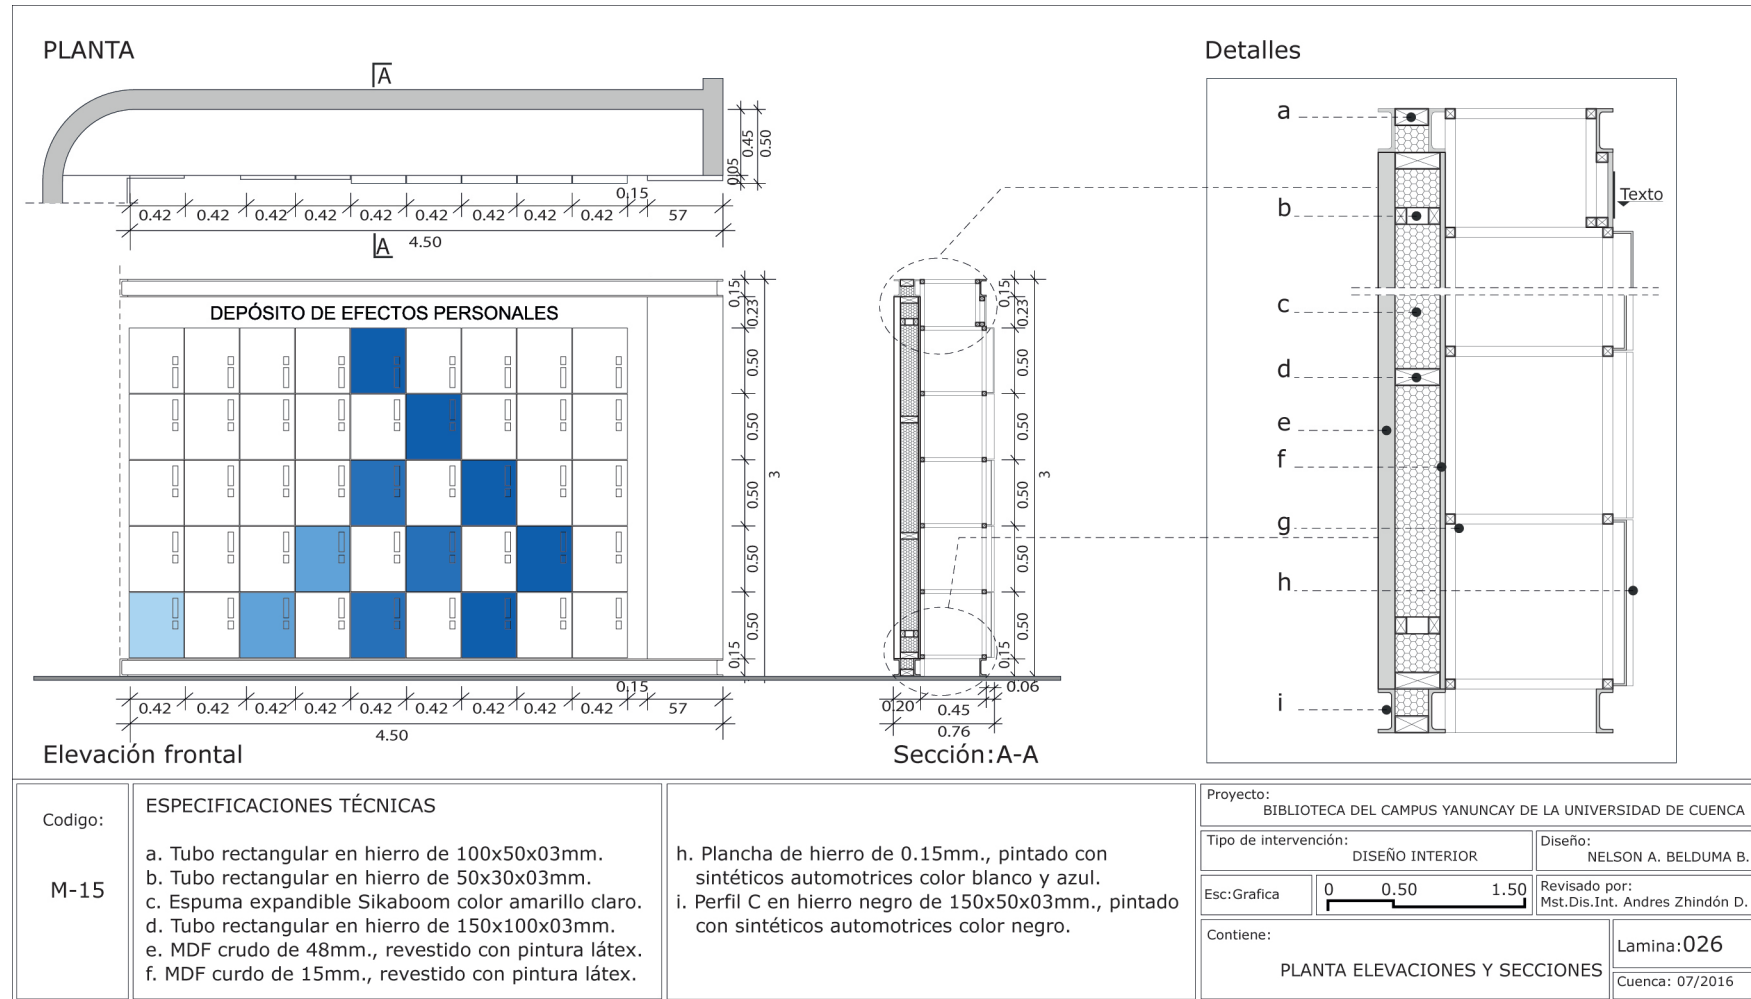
Planta, elevaciones y secciones. Área de taquillas. M-15.
